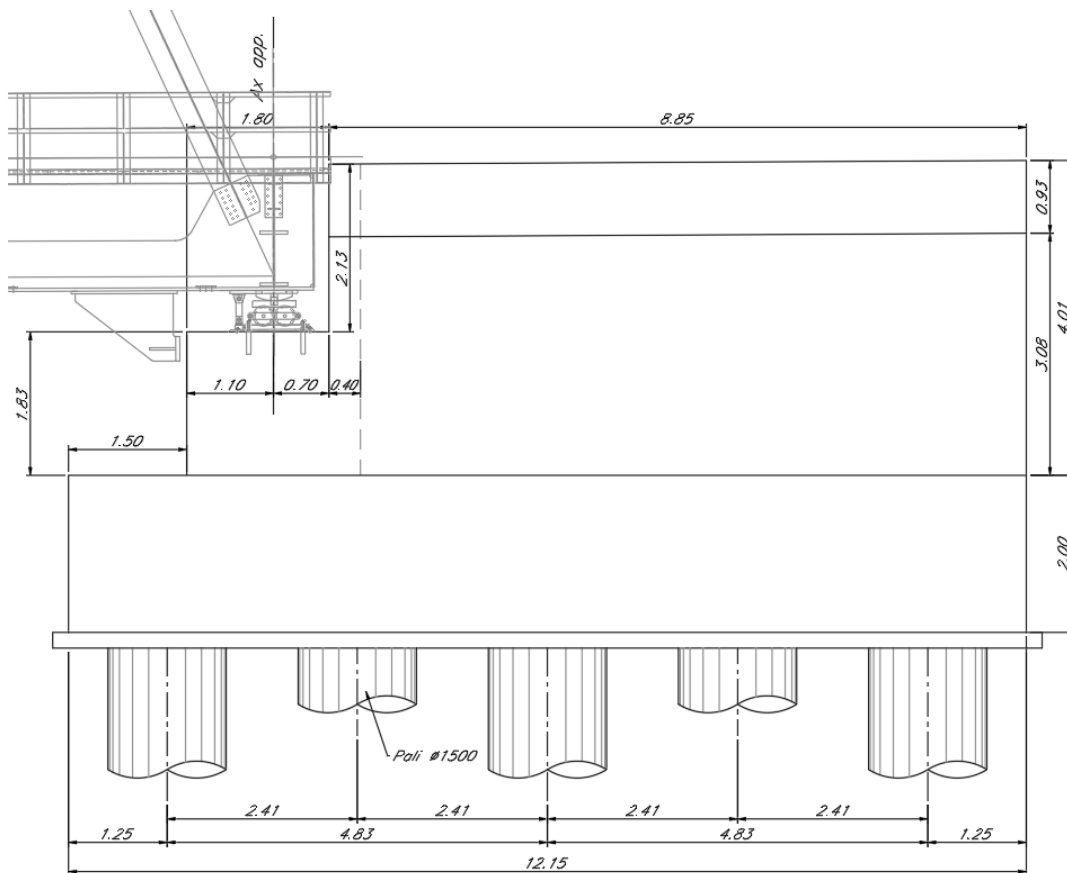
Prospetto Longitudinale Spalla B
